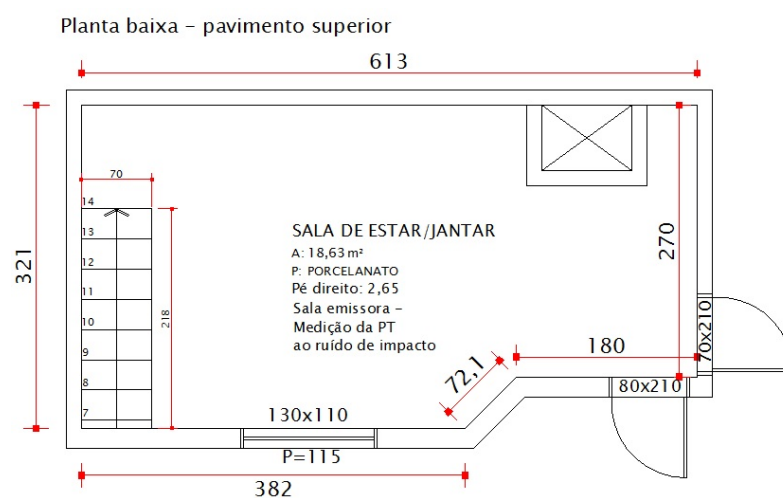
Planta baixa - pavimento superior - 11-R8-N-PC
